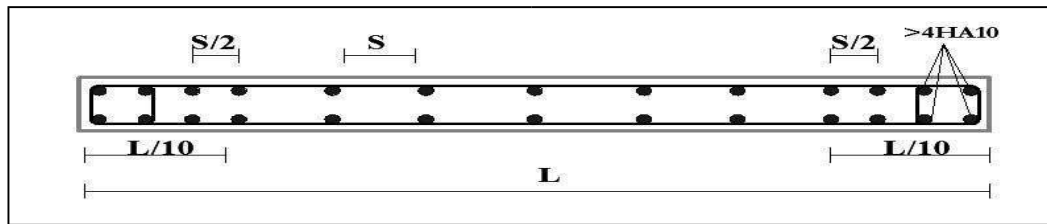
Disposition vertical des armatures dans les voiles
